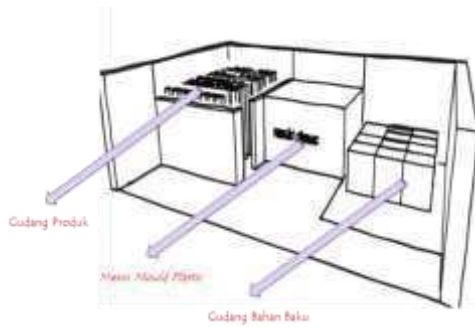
Denah Ruang Dalam Produksi Pabrik
